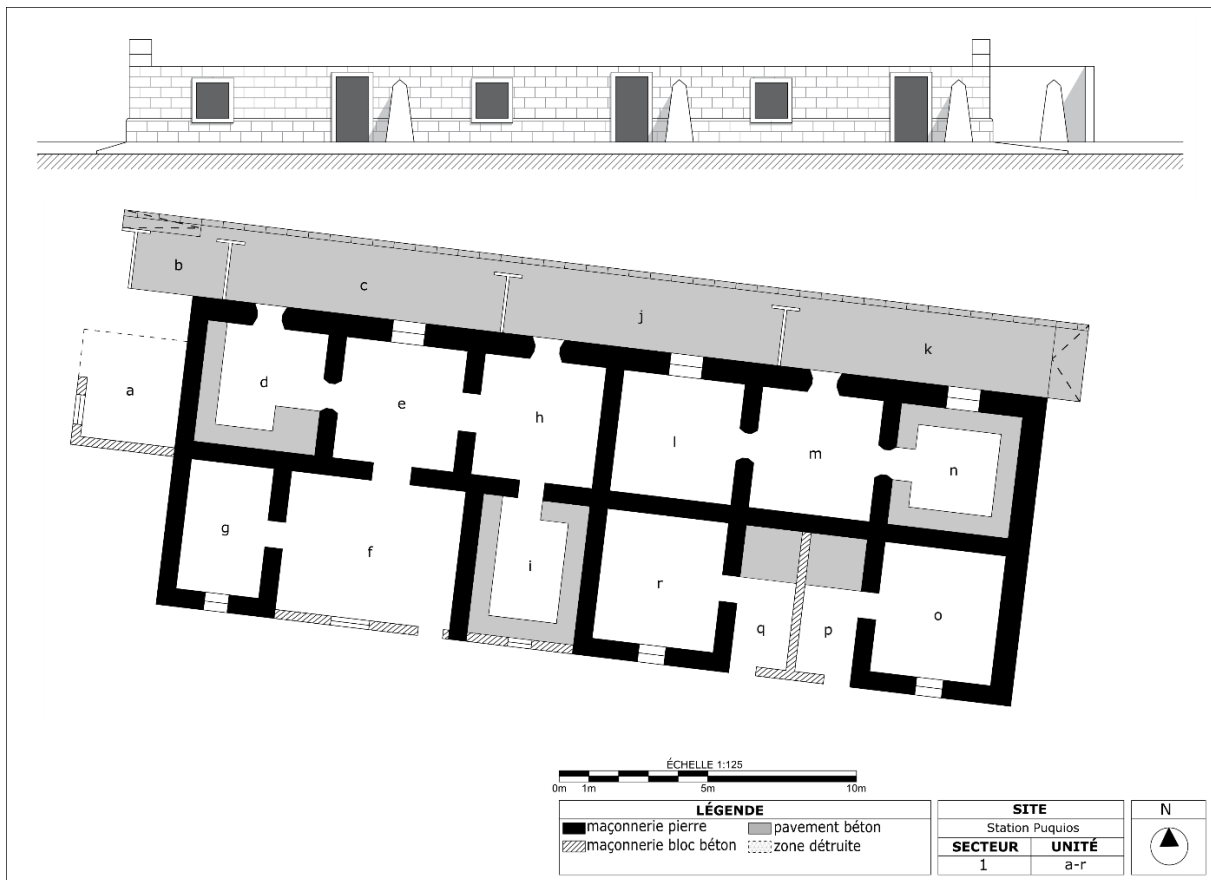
Station Puquios, plan du secteur 1 et élévation de la façade nord
